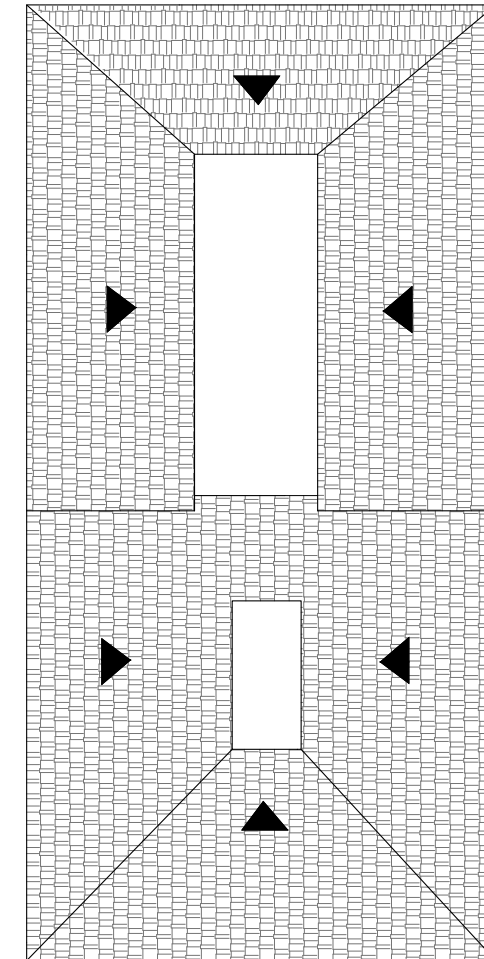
Identificación de elementos constructivos y materias en planta baja y alta, Cubierta
